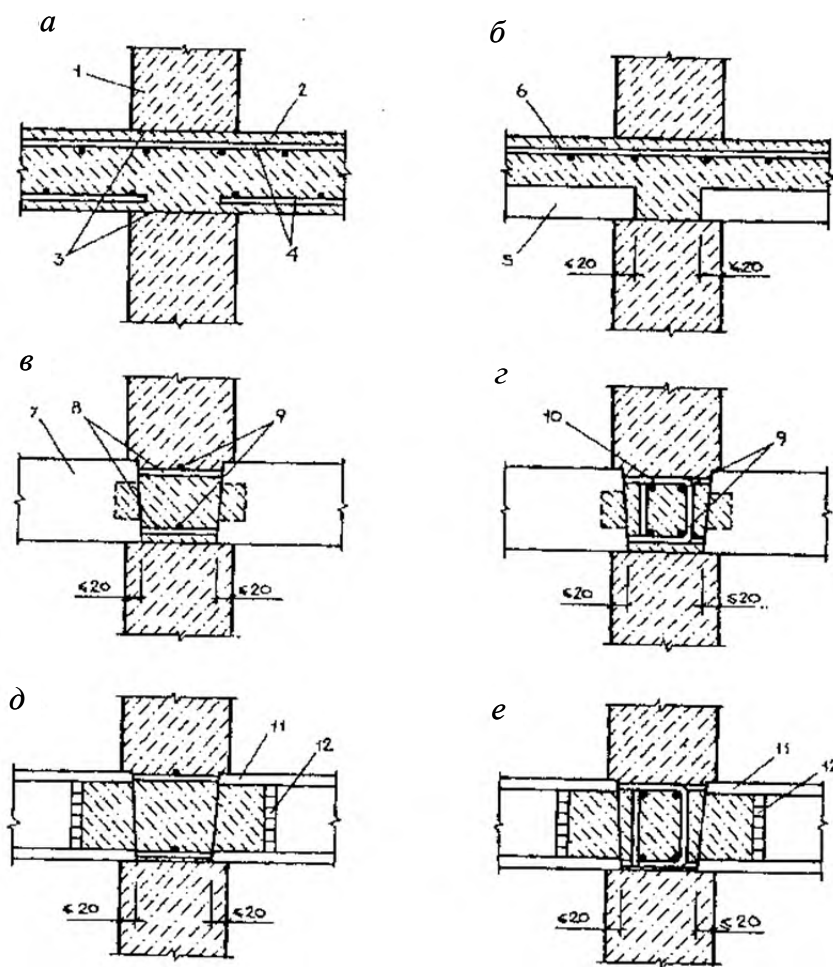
Контактные узлы внутренних монолитных стен:
